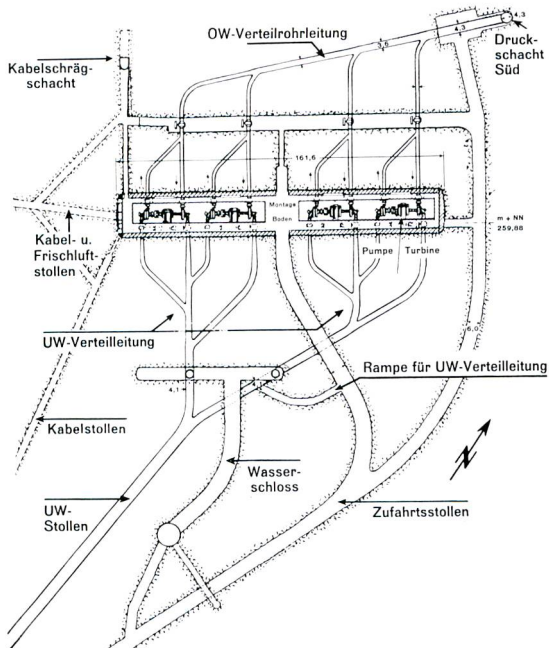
Grundriss der Kraftwerkskaverne Säckingen
